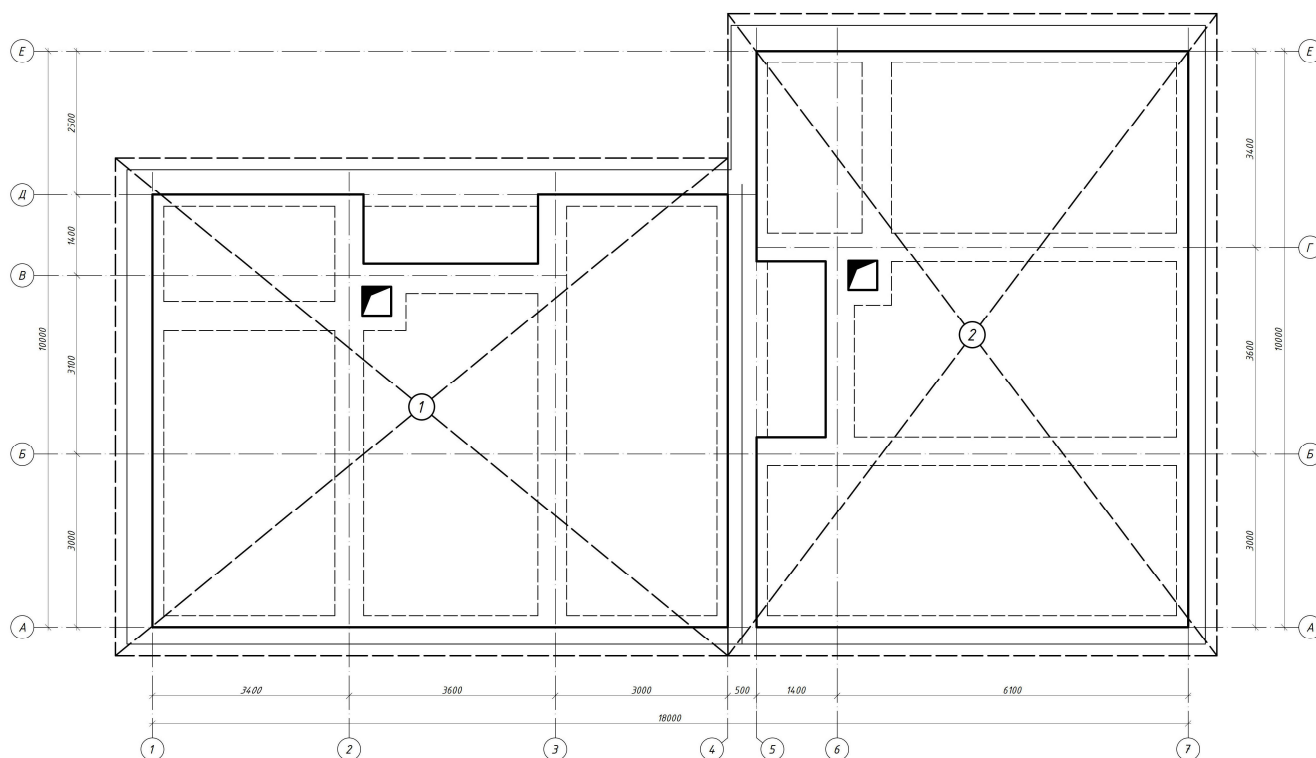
Розподіл будівлі на монтажні дільниці
